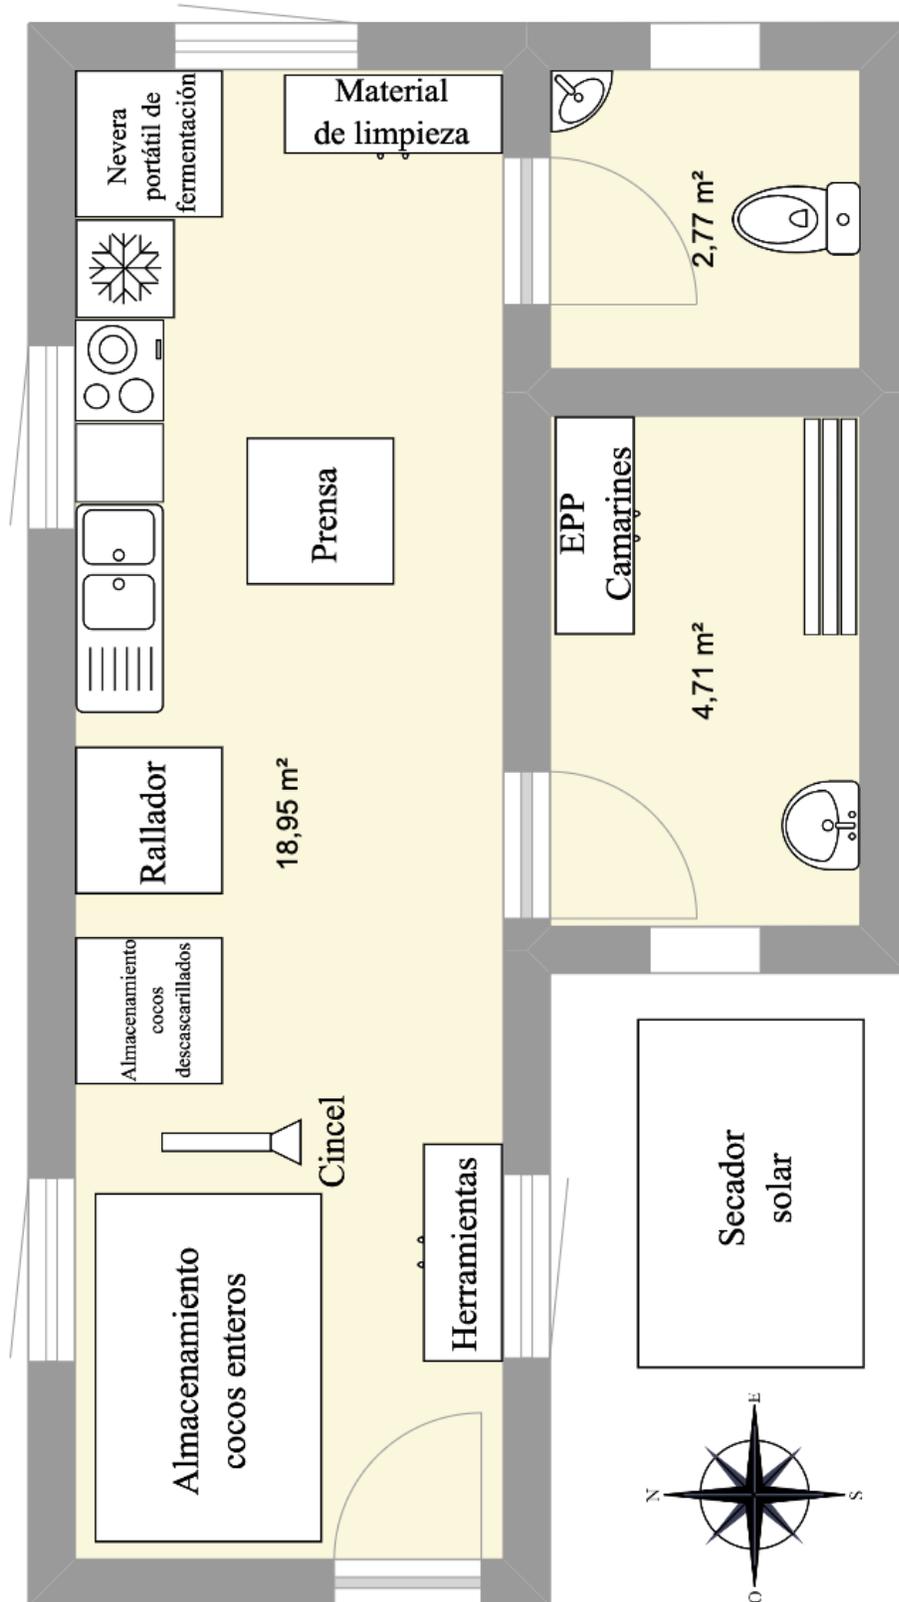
Propuesta de plan de planta (fuente: elaboración propia)
